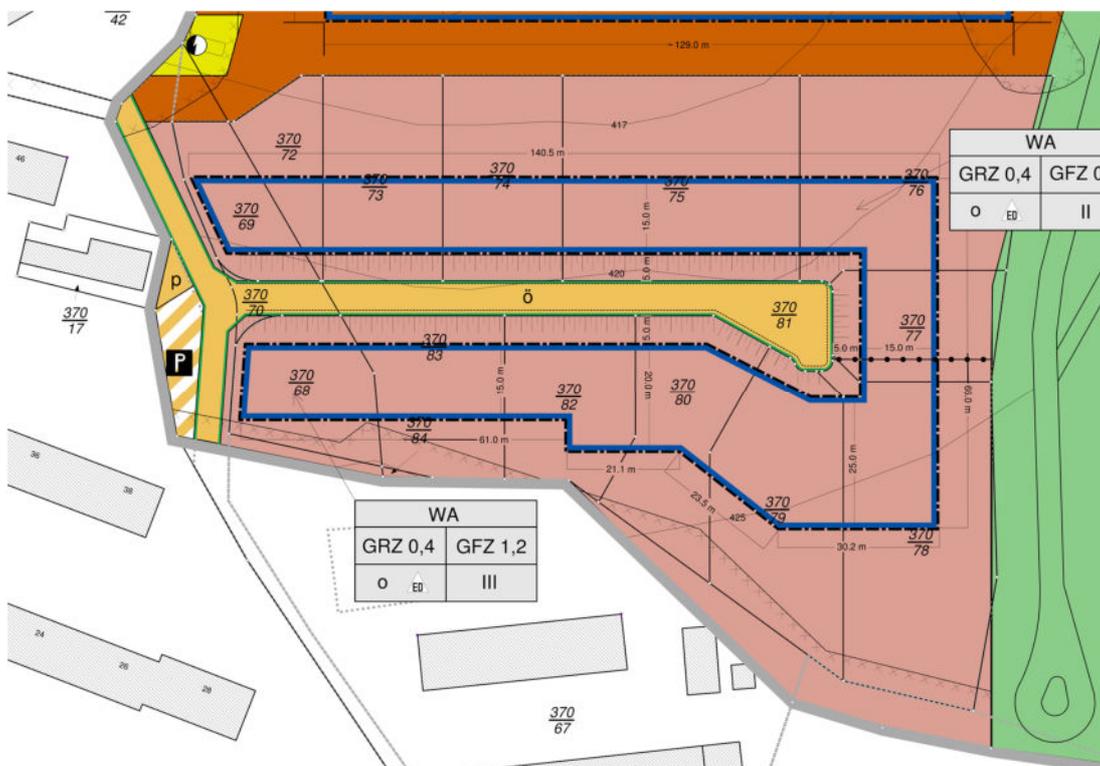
Auszug Planzeichnung, Stand Entwurf Mai 2024, 1. Änderung
